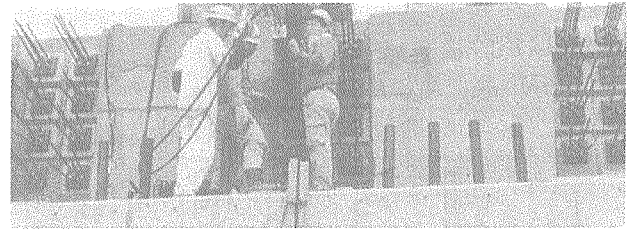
CCLジャッキによる緊張状況(桁の縦締め)
